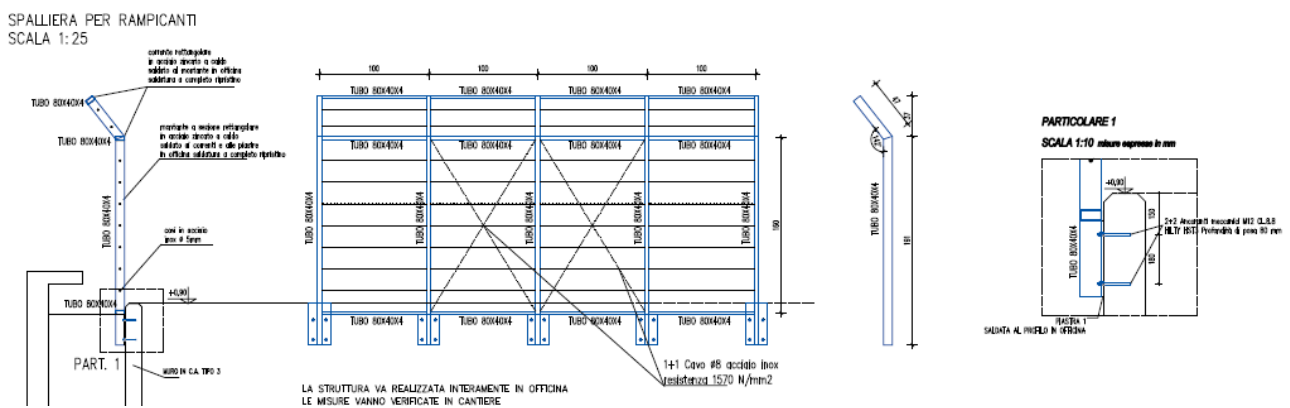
Particolarì Spalliere in carpenteria metallica
